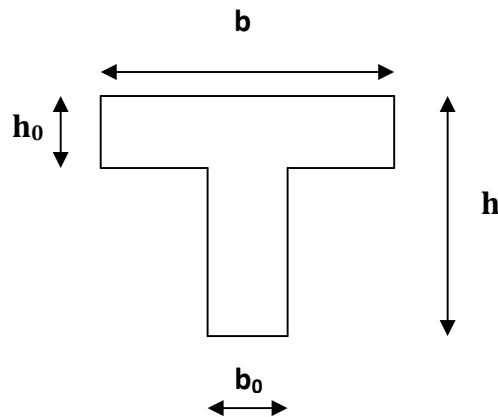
COUPE TRANSVERSALE D'UNE POUTRELLE
